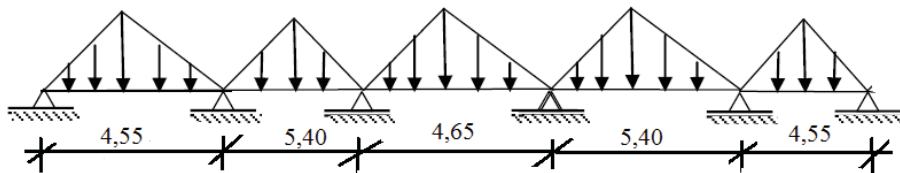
Distribution des charges sur les poutres secondaire.
